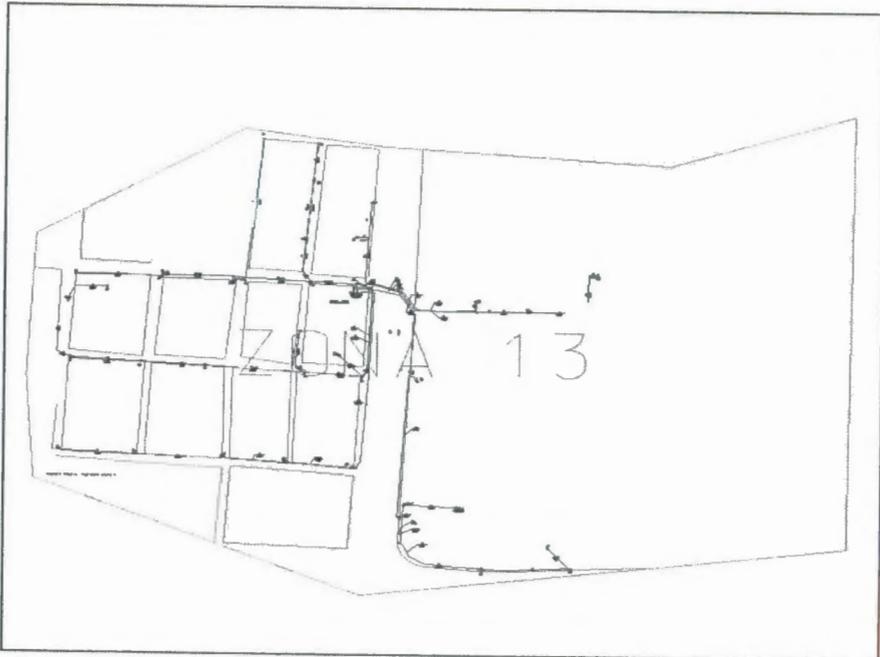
Planimetría zona 13 del sector de la vía a Daule
